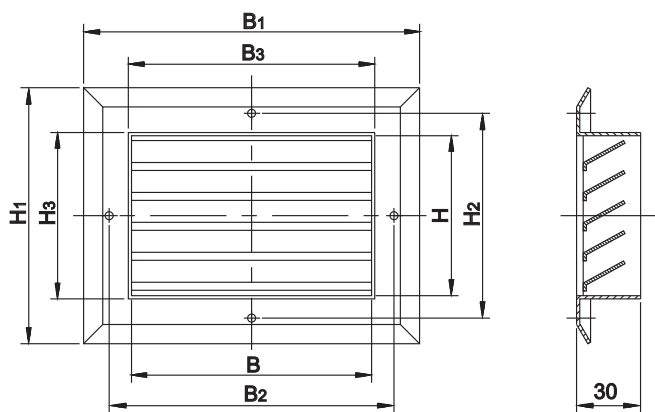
Схема установки решеток вентиляционных типа РШ-6 в стеновых проемах.
